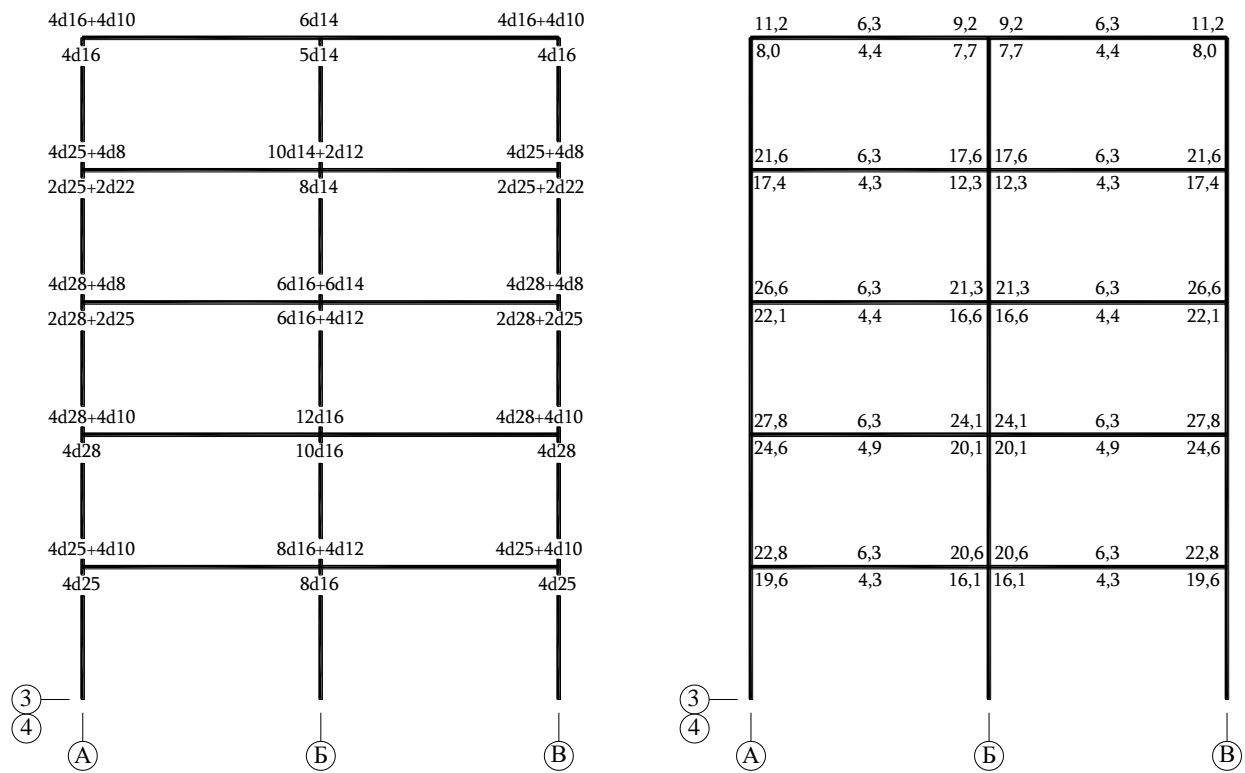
Продольное армирование балок рам, расположенных по осям 3 и 4, в соответствии с результатами конструирования:
